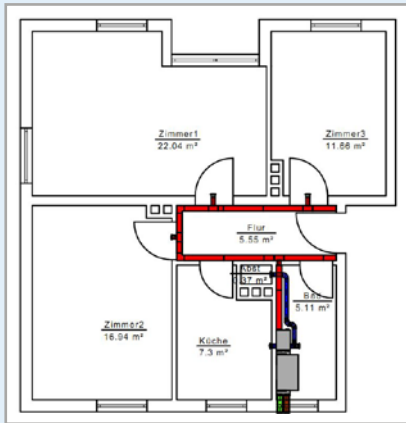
Darstellung des Lüftungskonzepts im Grundriss
